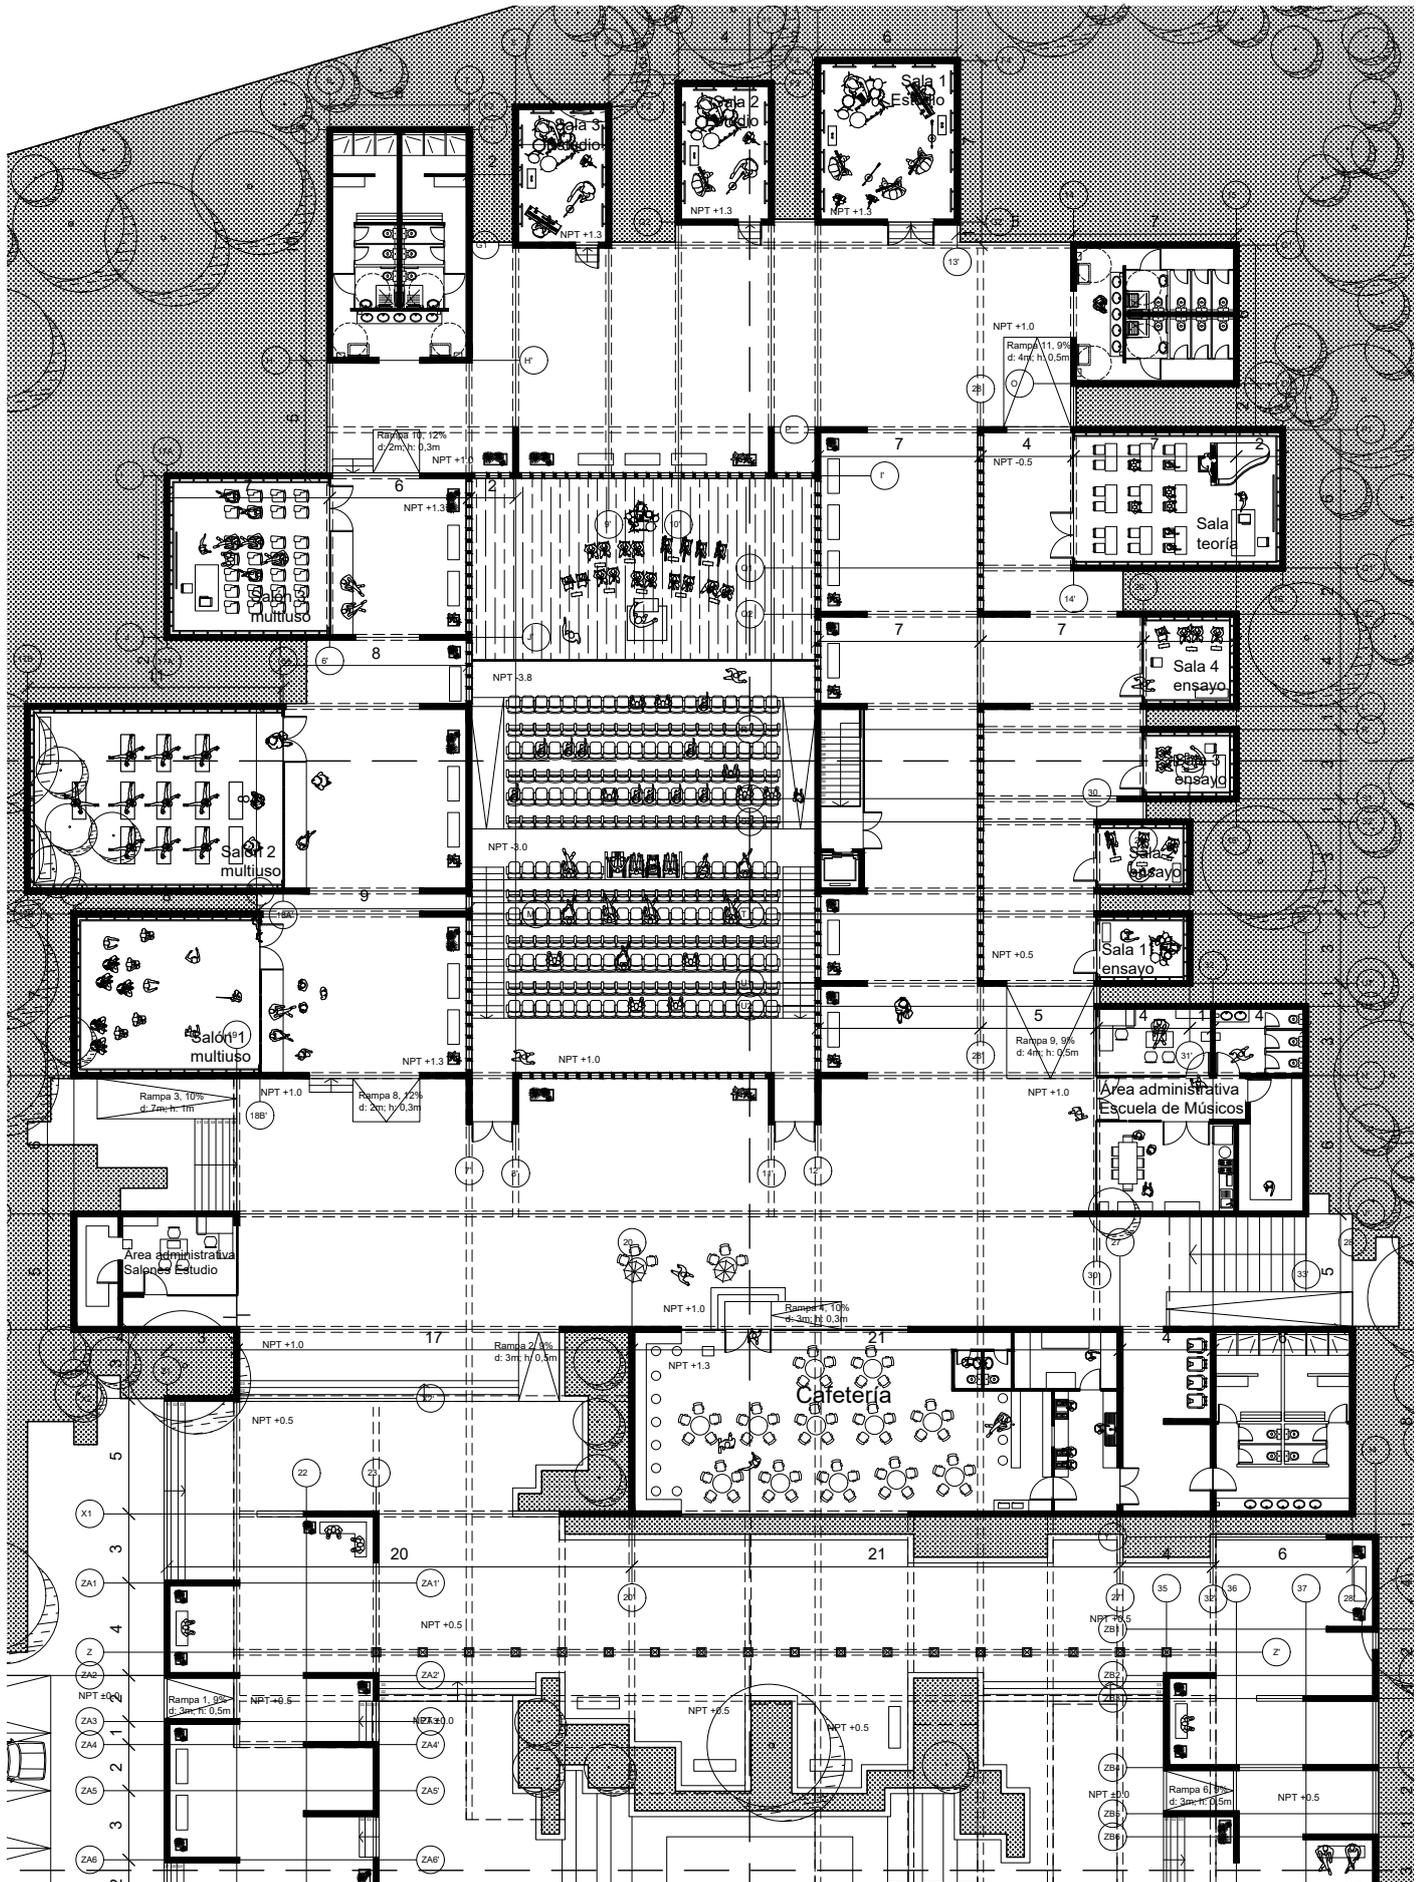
Planimetría, detalle de auditorio y espacio verde. (Elaboración propia)
